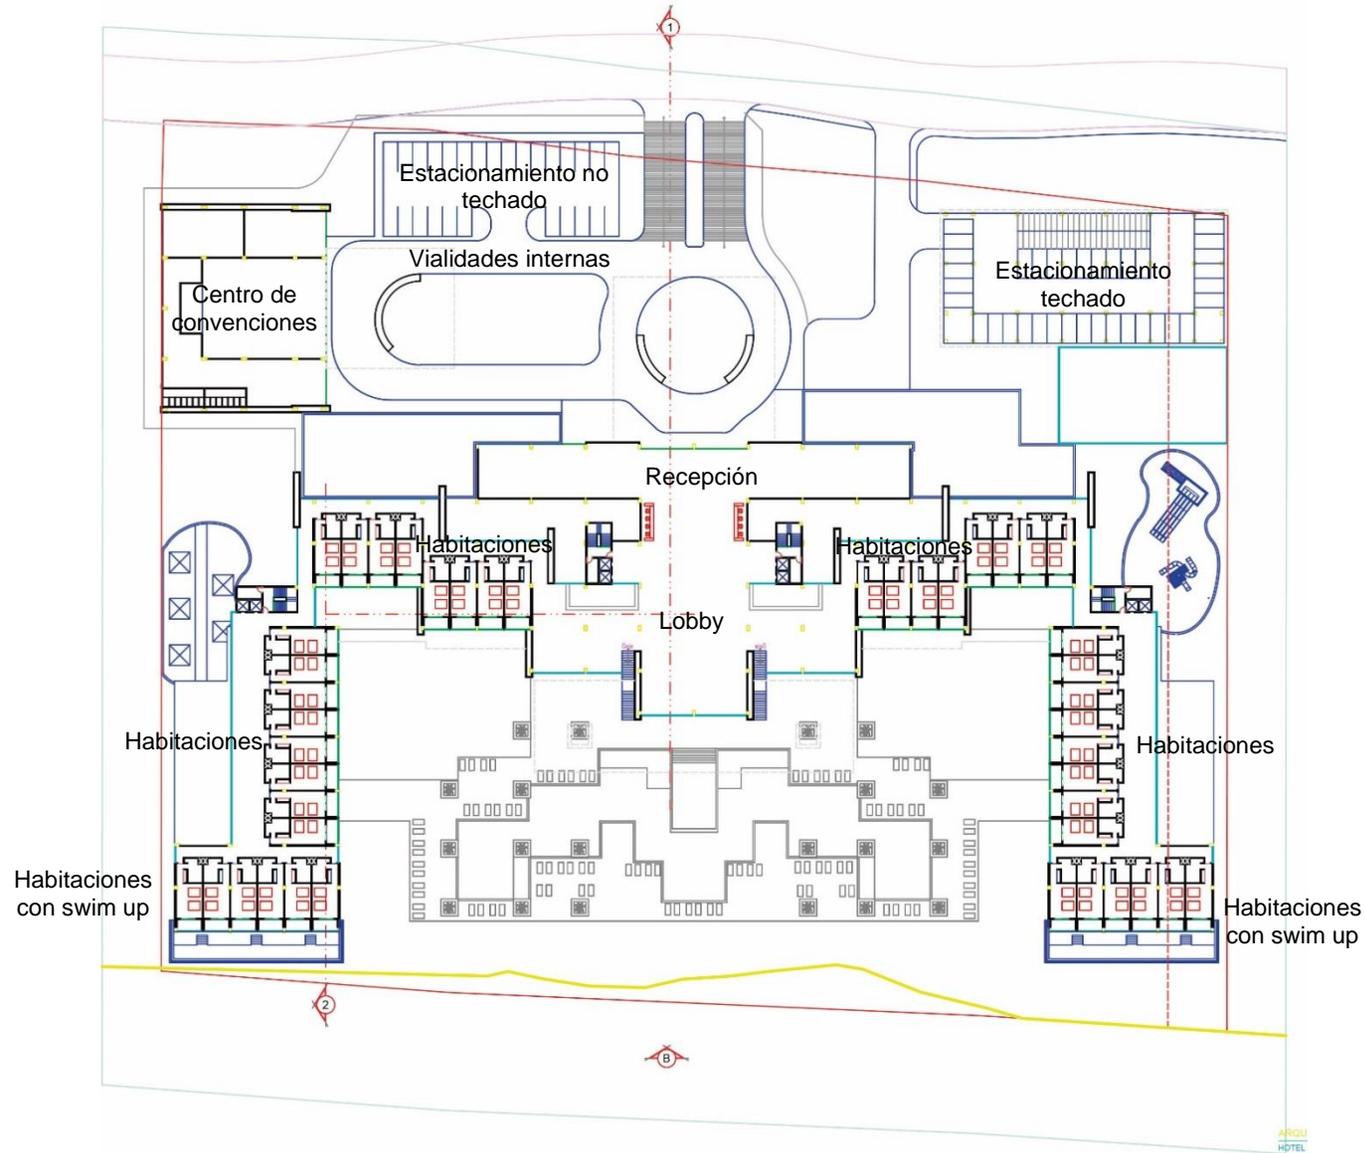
Se presenta la planta del primer y segundo nivel. Las habitaciones con Swim up solo se desplantan en planta baja y primer nivel.
